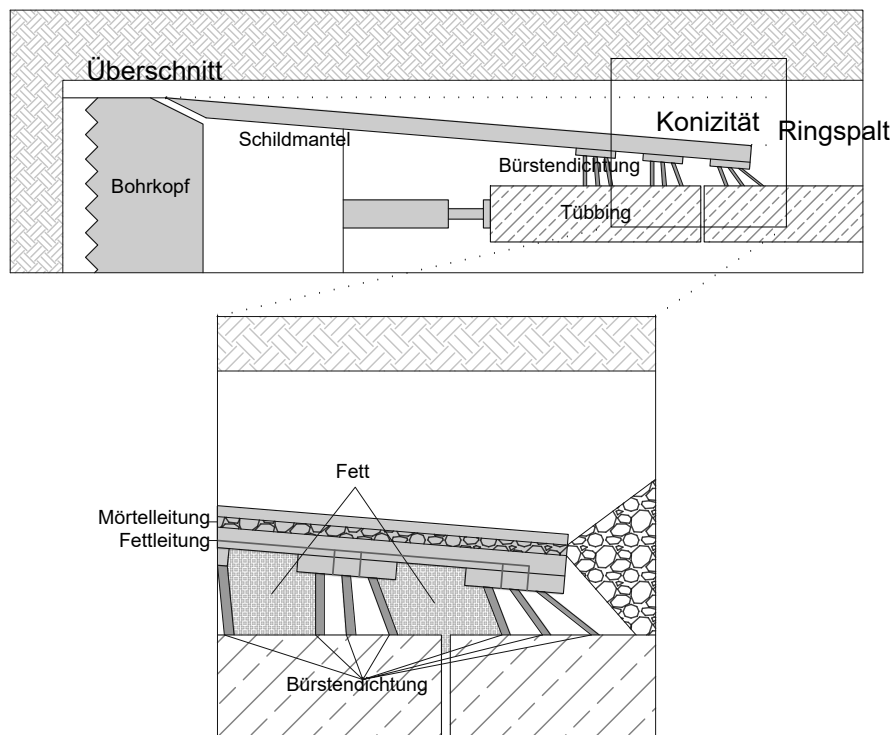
Darstellung des Schildes mit Ringspalt und Schildschwanzdichtung (Quelle: modifiziert nach Hausmann [37, 24 ff.])
